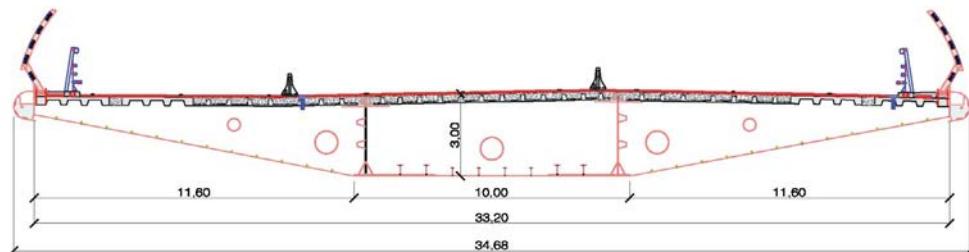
Sección transversal del viaducto de acceso al lado de Cádiz.
